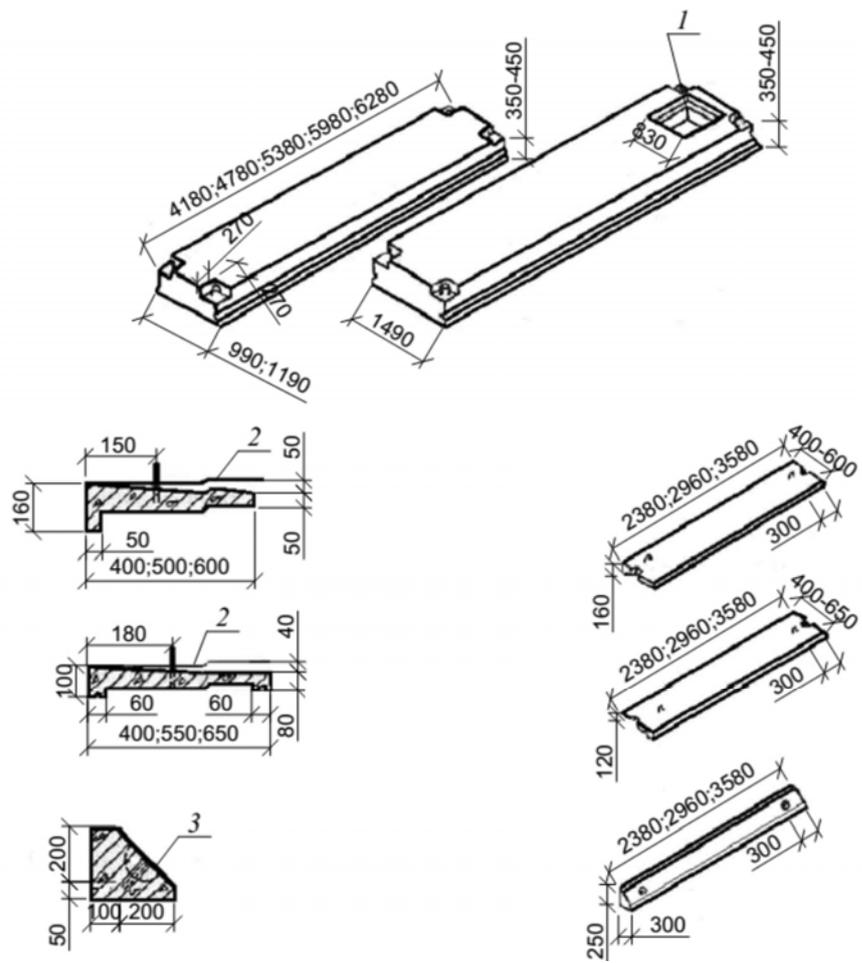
Керамзитобетонные вентилируемые плиты для совмещенных крыш с наружным водостоком с продольными каналами $\varnothing 60$ (серия 1.165): 1 — люк 800 × 600 для выхода на крышу; 2 — парпетные плиты; 3 — бортовой камень
